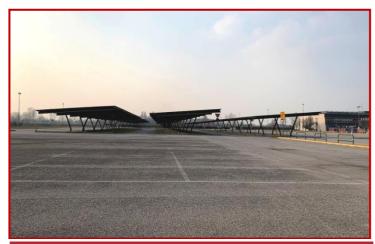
Vista dell'impianto fotovoltaico su pensiline
